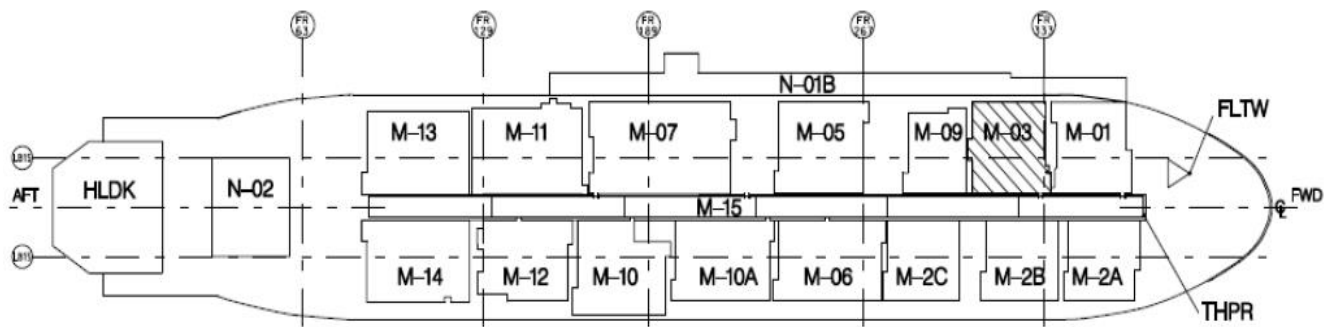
Vista superior do casco da P-58 com destaque para o módulo 03
